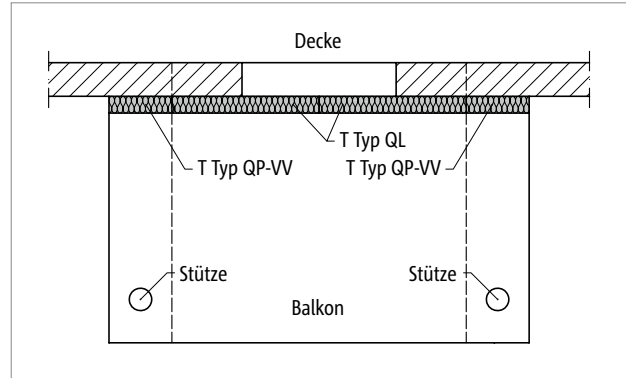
Schöck Isokorb® T Typ QP-VV und Typ QL: Balkon mit Stützenlagerung, Anschluss bei unterschiedlichen Auflagersteifigkeiten
